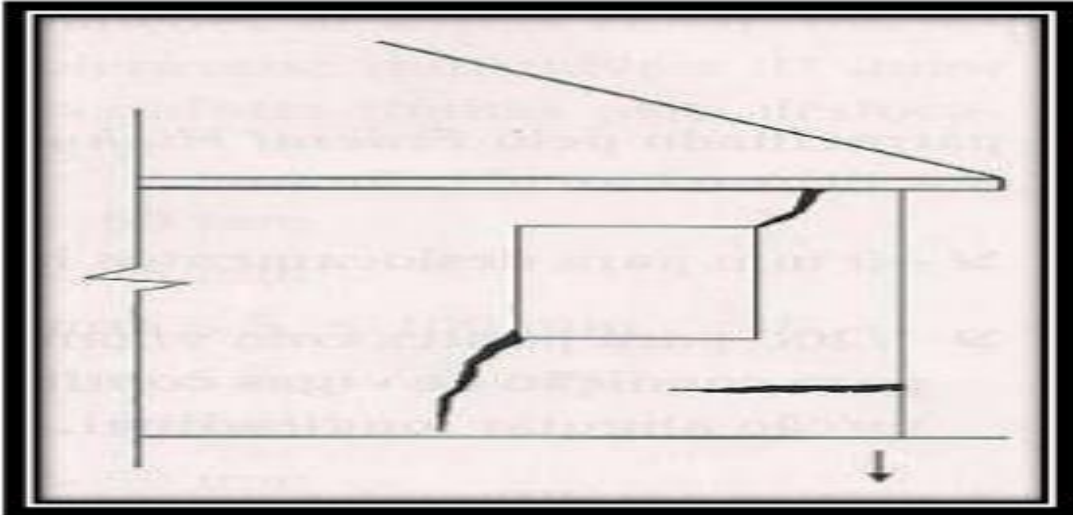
Fissuras em parede decorrente de recalque na extremidade
